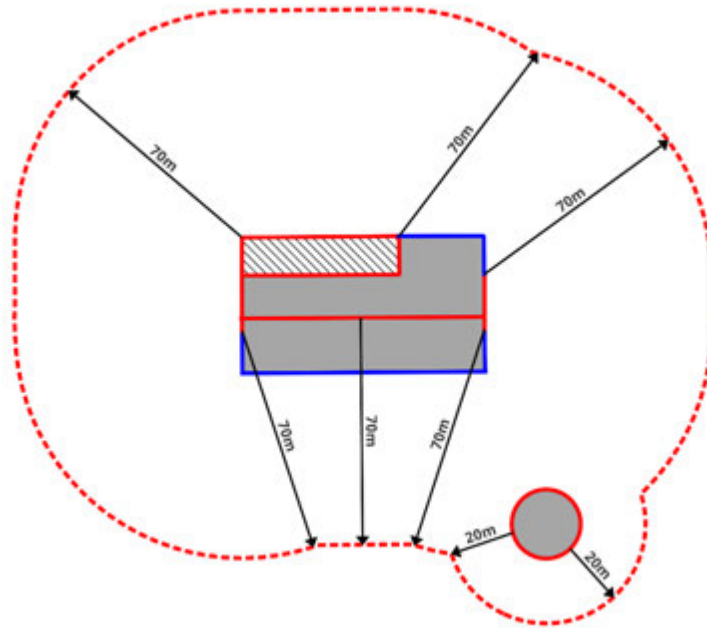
Bemessung der Abstände am Beispiel eines Rinderstalls mit Laufhof (schraffiert). Entlüftung des Stalls über Laufhof, seitliche Tore und Lichtfirst. Das gedeckte Güllelager ist räumlich abgesetzt. Blau dauerhaft geschlossene Fassadenteile. Bemessungslinien des Mindestabstandes des Stalls sind offene Fassadenteile, Rand des Laufhofes und Lichtfirst (rote Linie in der Mitte des Stalls). Das Güllelager hat eine eigene Bemessungslinie mit Abstand 20 m. Rot gestrichelte Linie: Umhüllungslinie.
